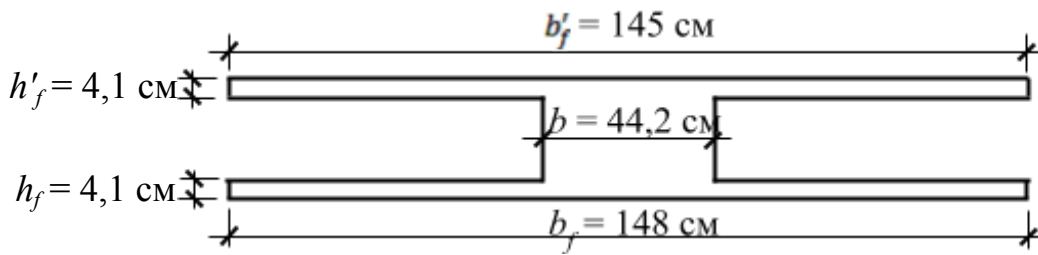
Еквівалентний поперечний переріз багатопустотної панелі перекриття.
